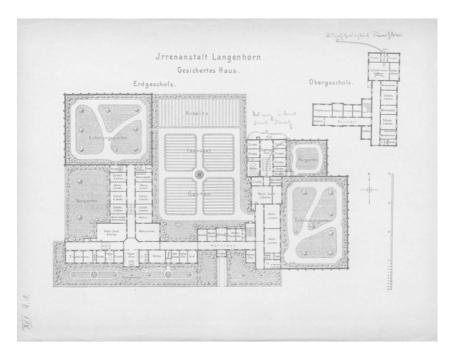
Grundriss des gesicherten Hauses in der Irrenanstalt Langenhorn.¹¹
